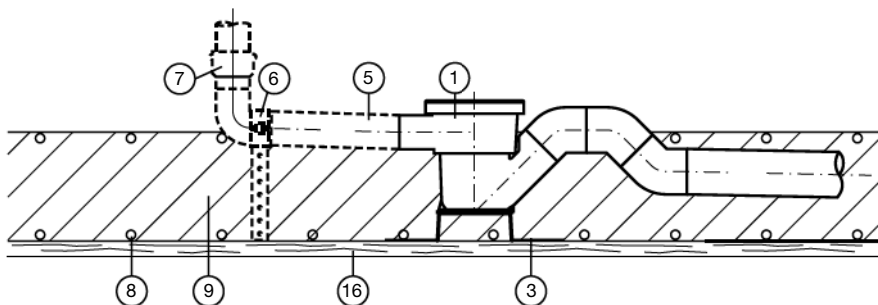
Pose dans la dalle en béton, montée sur le coffrage
